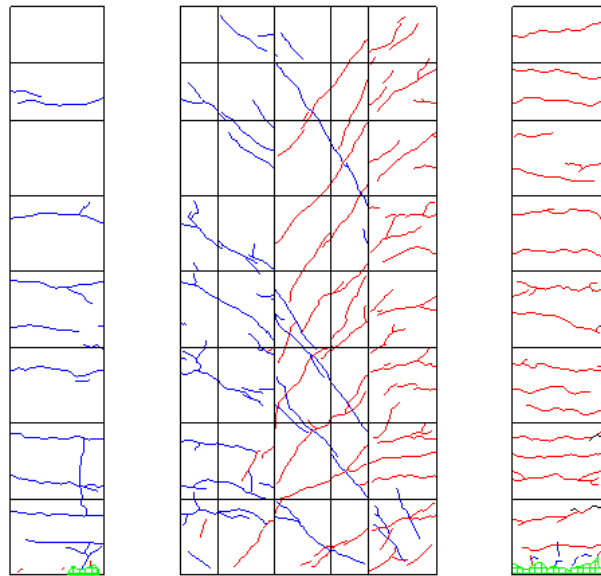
R=-1/50②ひび割れ図
